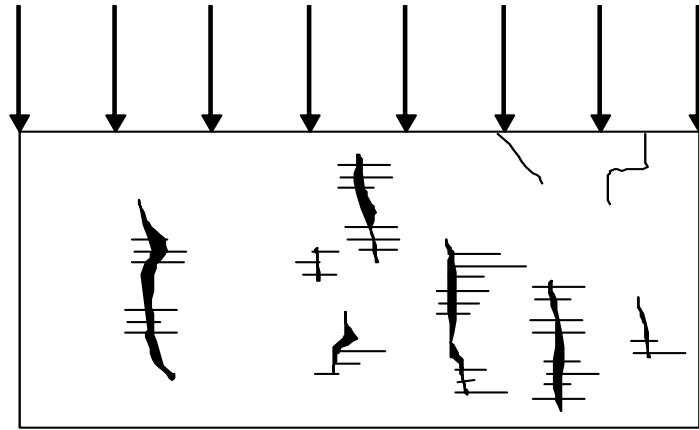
Fissuração típica da alvenaria causada por sobrecarga vertical (adaptado de THOMAZ, 1989).
